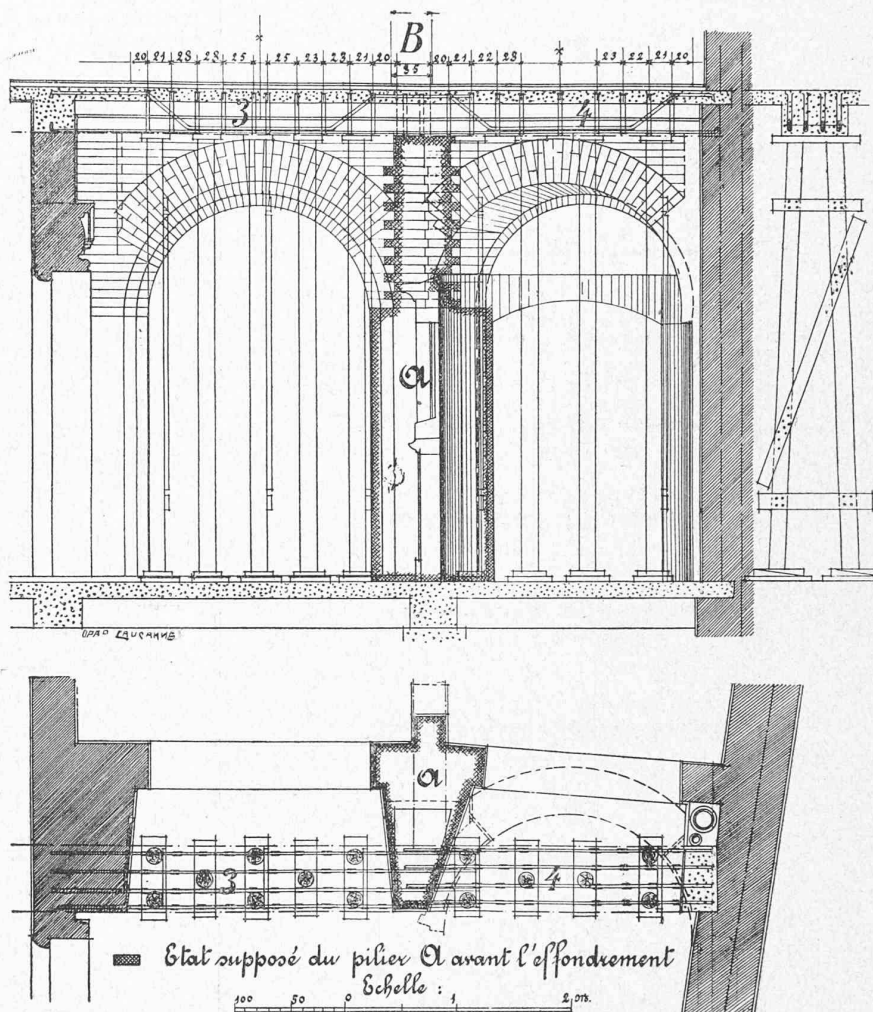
Disposition du pilier, du sommier et des voûtes dans le vestibule du rez-de-chaussée.
